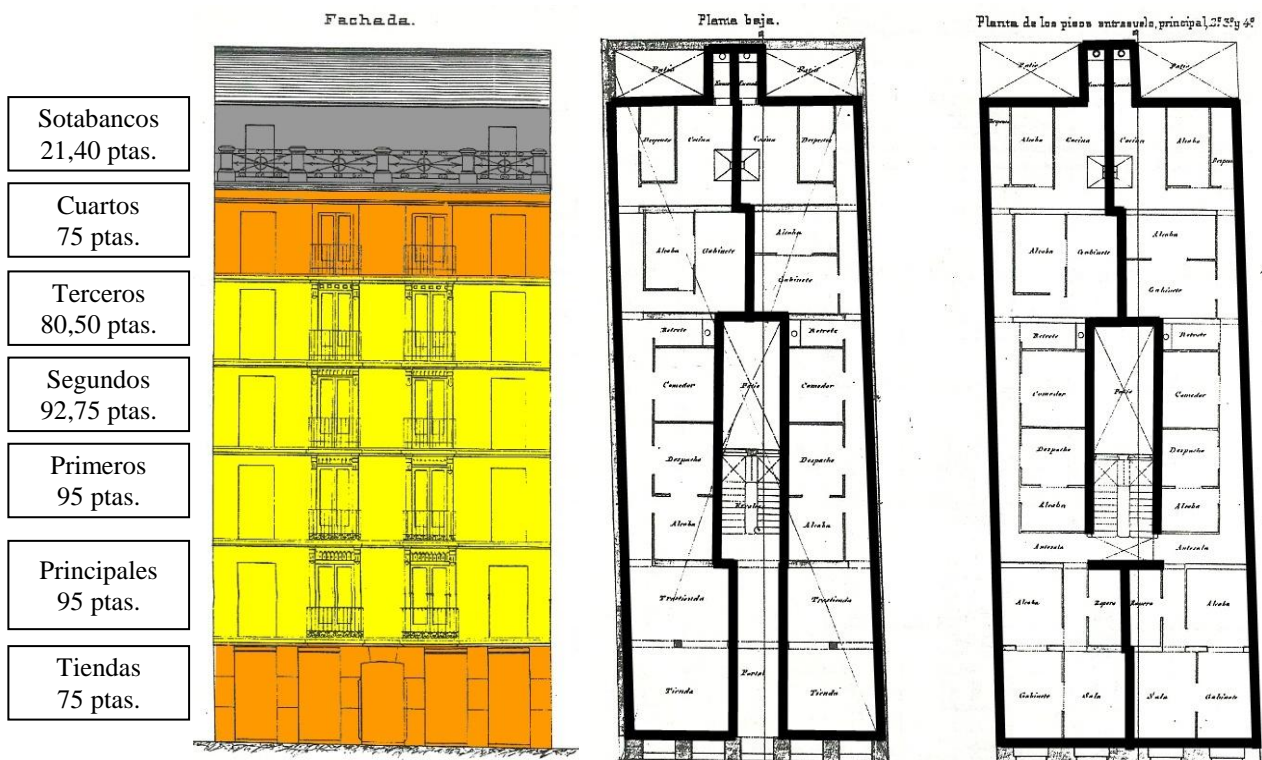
Planos de la fachada e interiores del inmueble de la calle Lagasca nº 8 propiedad de José Puente y Sierra edificado en 1894. AVM, Secretaría, signatura 9-481-5. Los datos de los alquileres proceden del padrón de Madrid de 1905 de dicho número. Los alquileres son mensuales. Los colores indican la escala de alquileres de la Figura 4.8.
